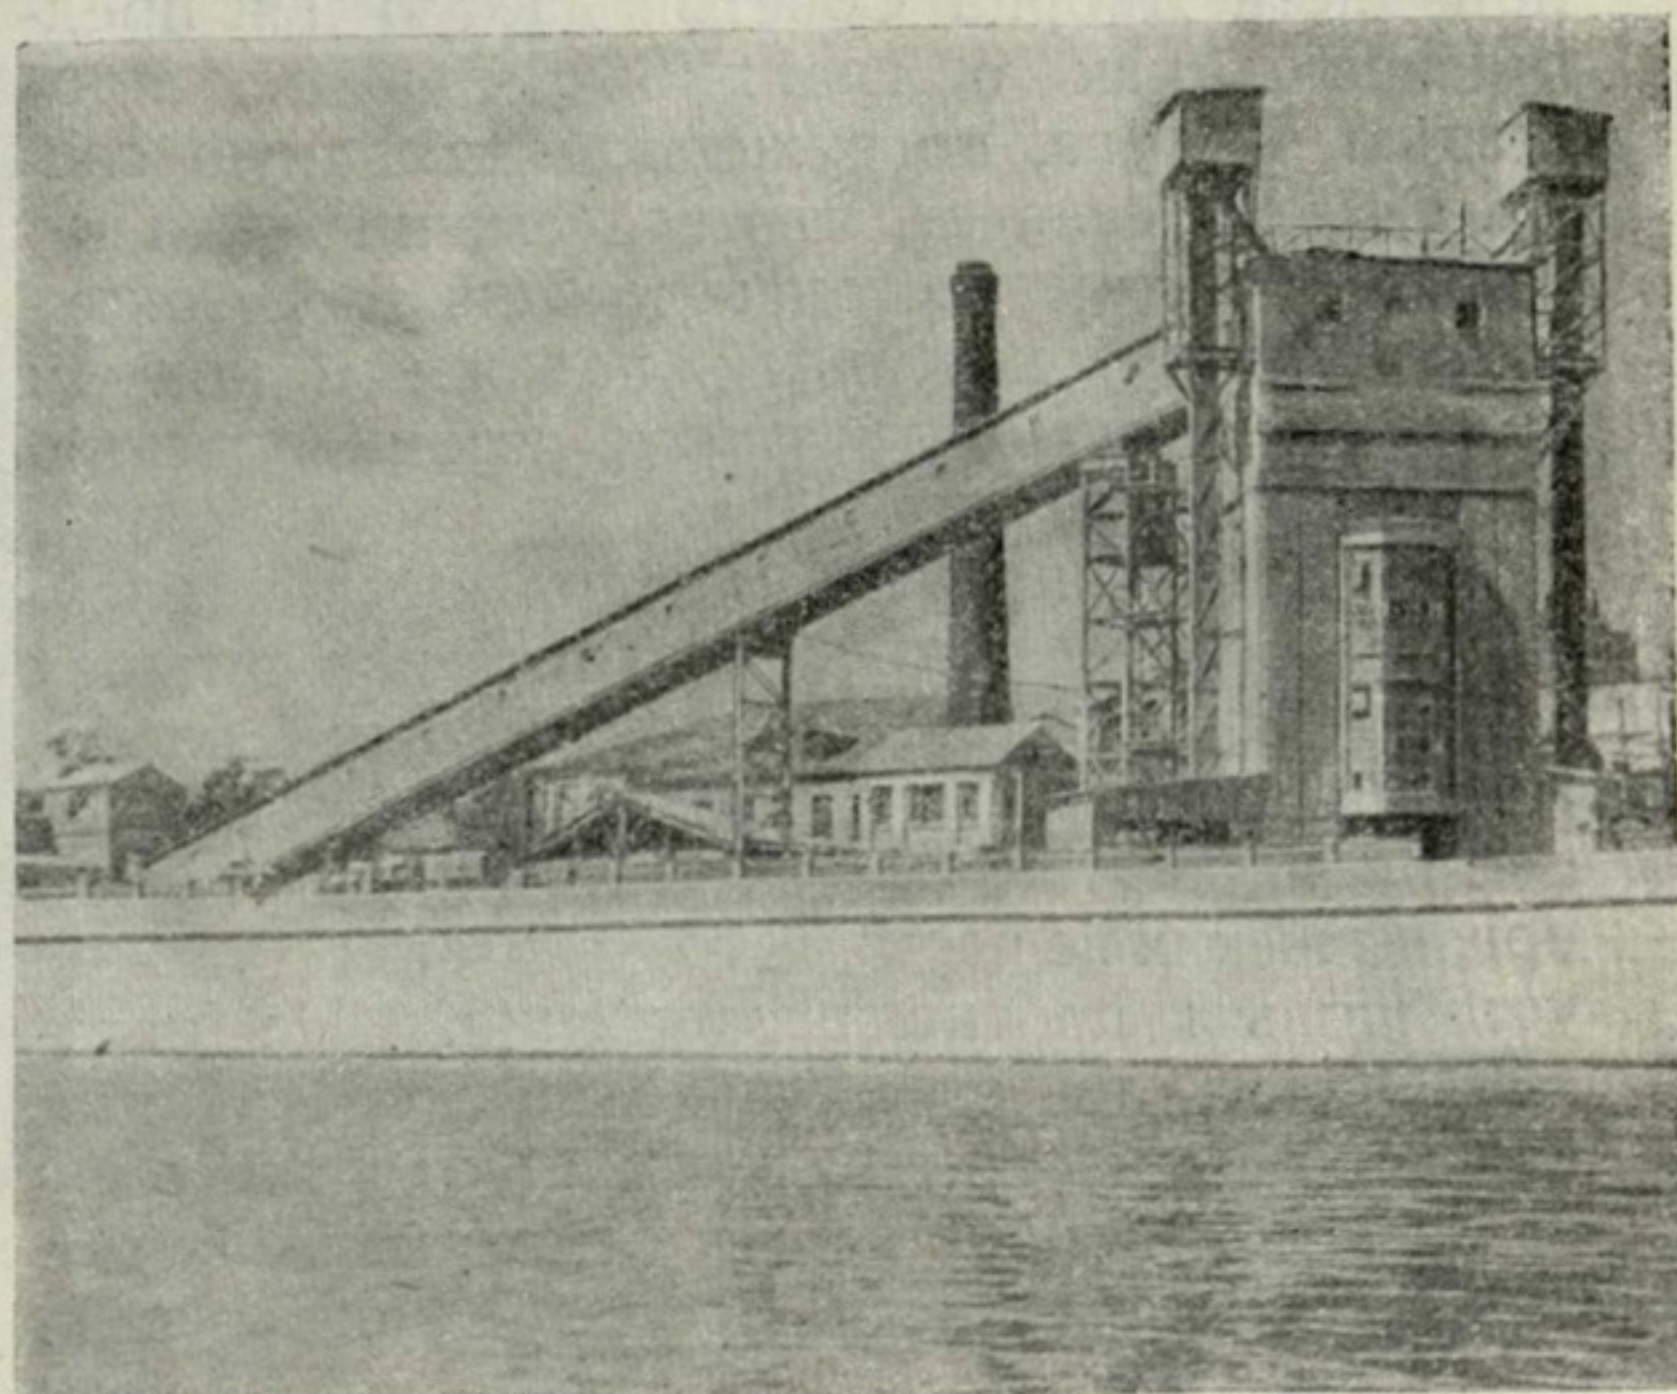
Бетонный завод строительства Дворца Советов, расположенный на расстоянии 600 м от строительной площадки.
